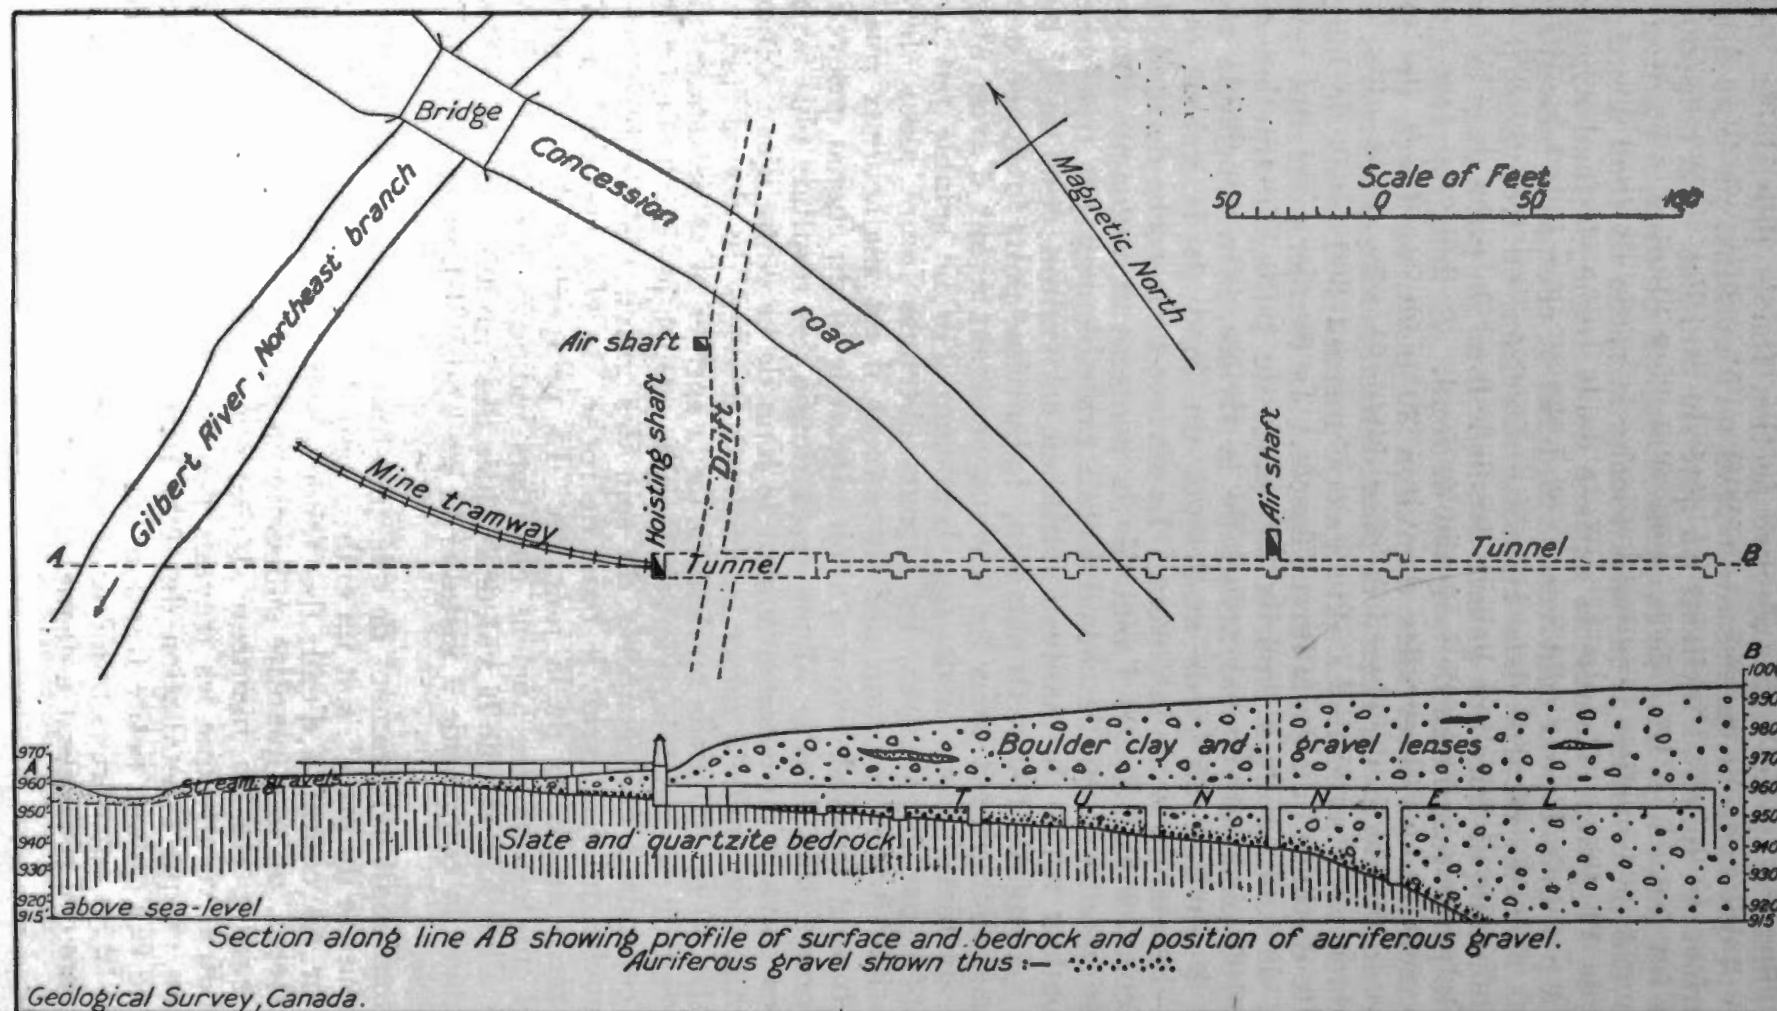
Plan et coupe des chantiers profonds, rivière Gilbert.
